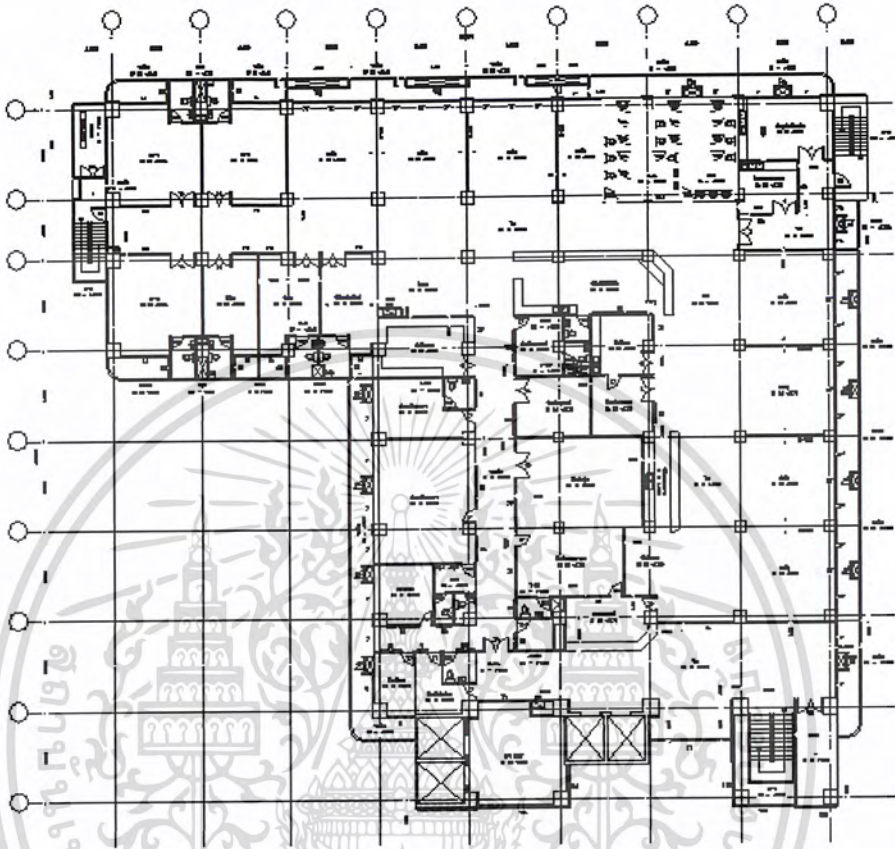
แสดง พื้นที่ชั้น 4 th FLOOR PLAN
